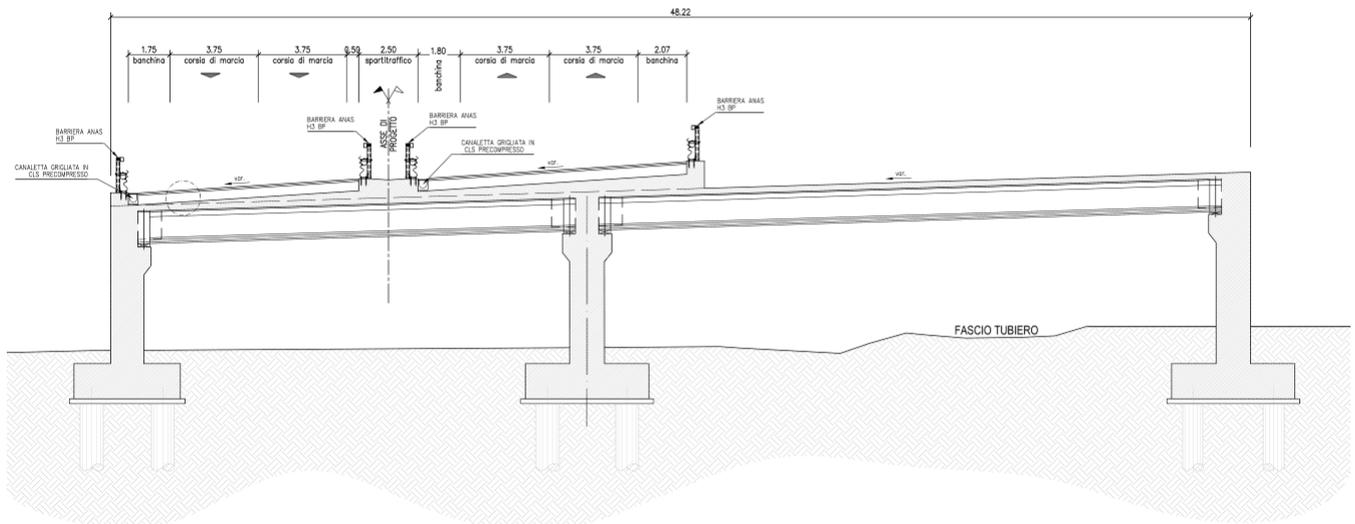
Sezione tipo dell'asse principale su opera di attraversamento
